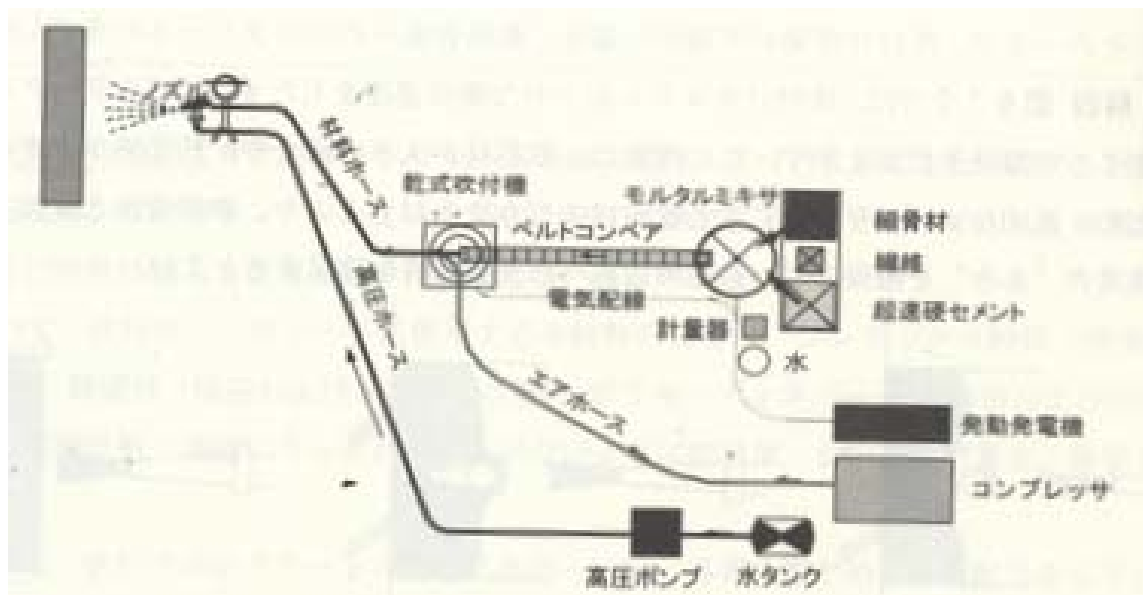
乾式吹付け工法の施工システム例⁴⁾
